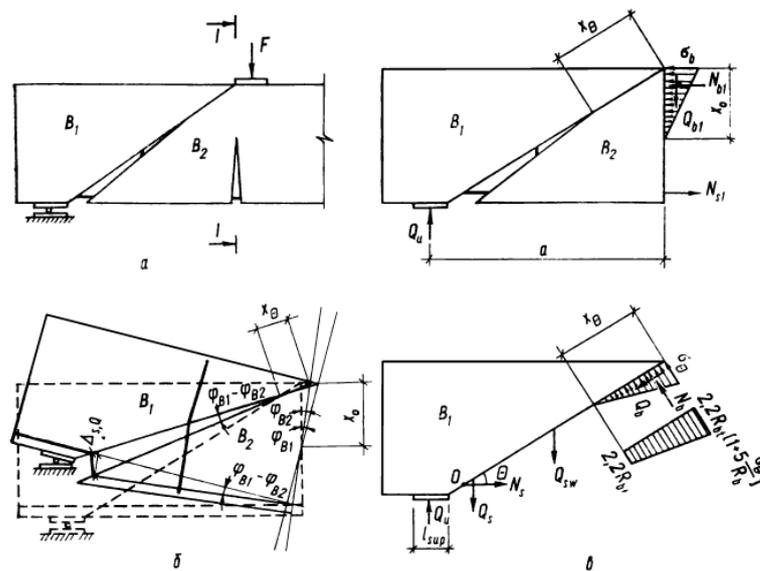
Физическая модель (а), кинематическая схема деформирования (б) и расчетная модель предельного равновесия (в) при разрушении в результате среза бетона сжатой зоны над наклонной трещиной [1]
